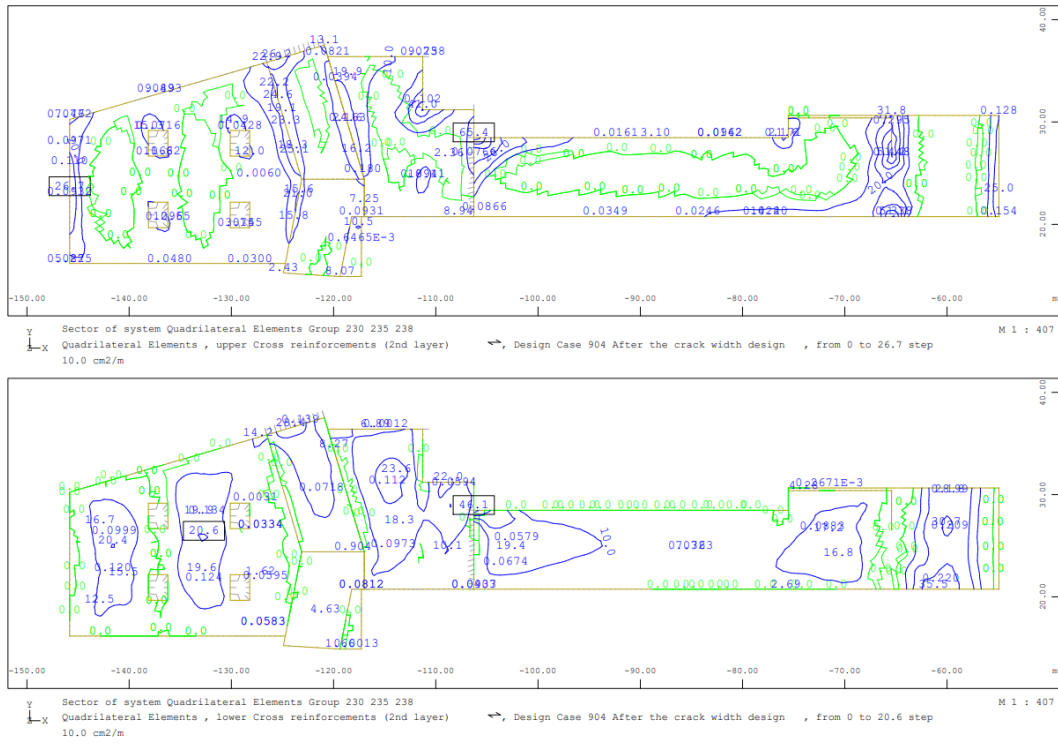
Armadura secundária na face superior (sup.) e inferior (inf.) – laje de cobertura – acesso Norte - ELS
